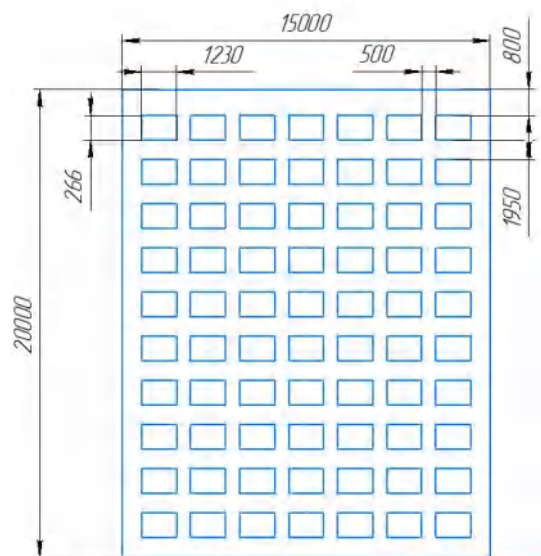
План помещения и размещения светильников с люминесцентными лампами.
